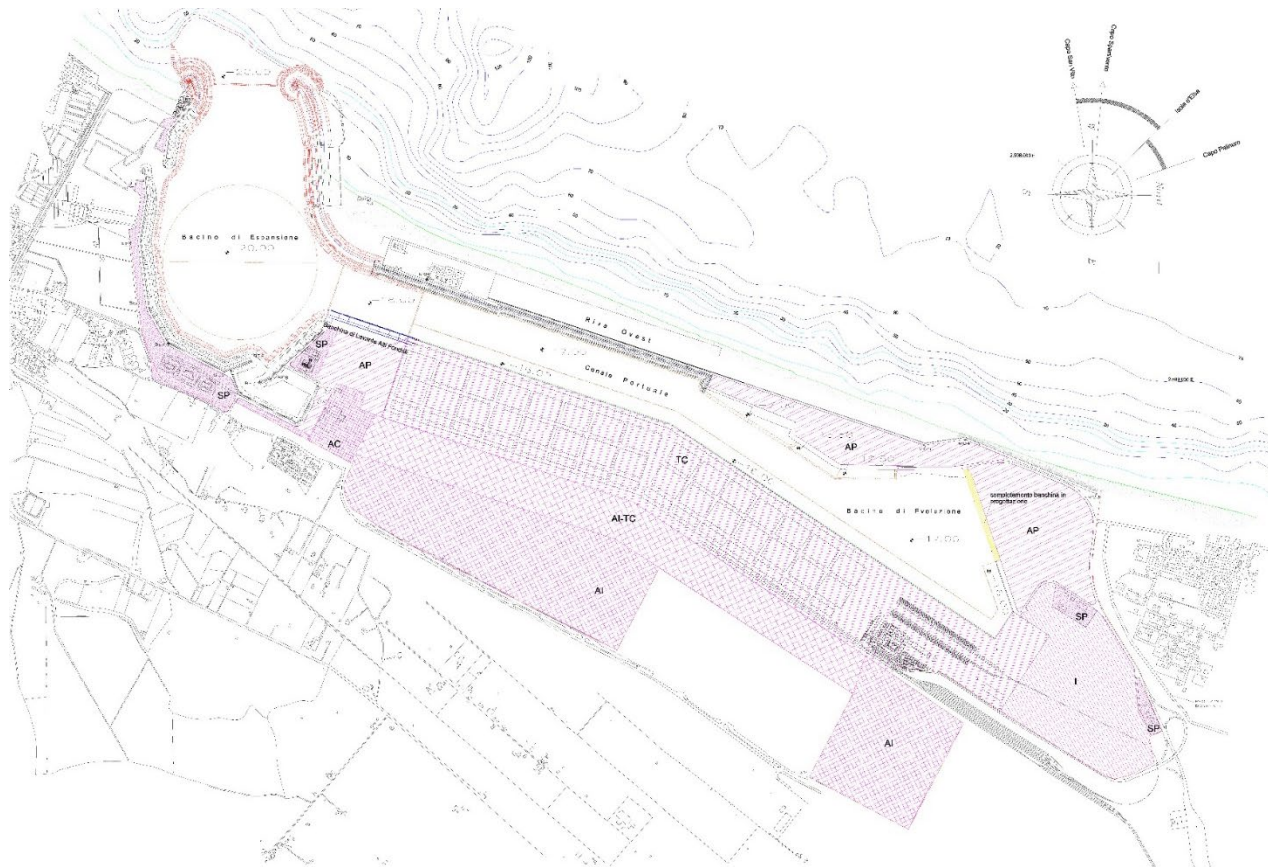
Stralcio ATF 2005 – Planimetria piano pescaggi
